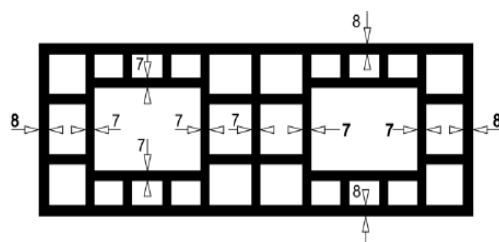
Planta do bloco estrutural de paredes vazadas
